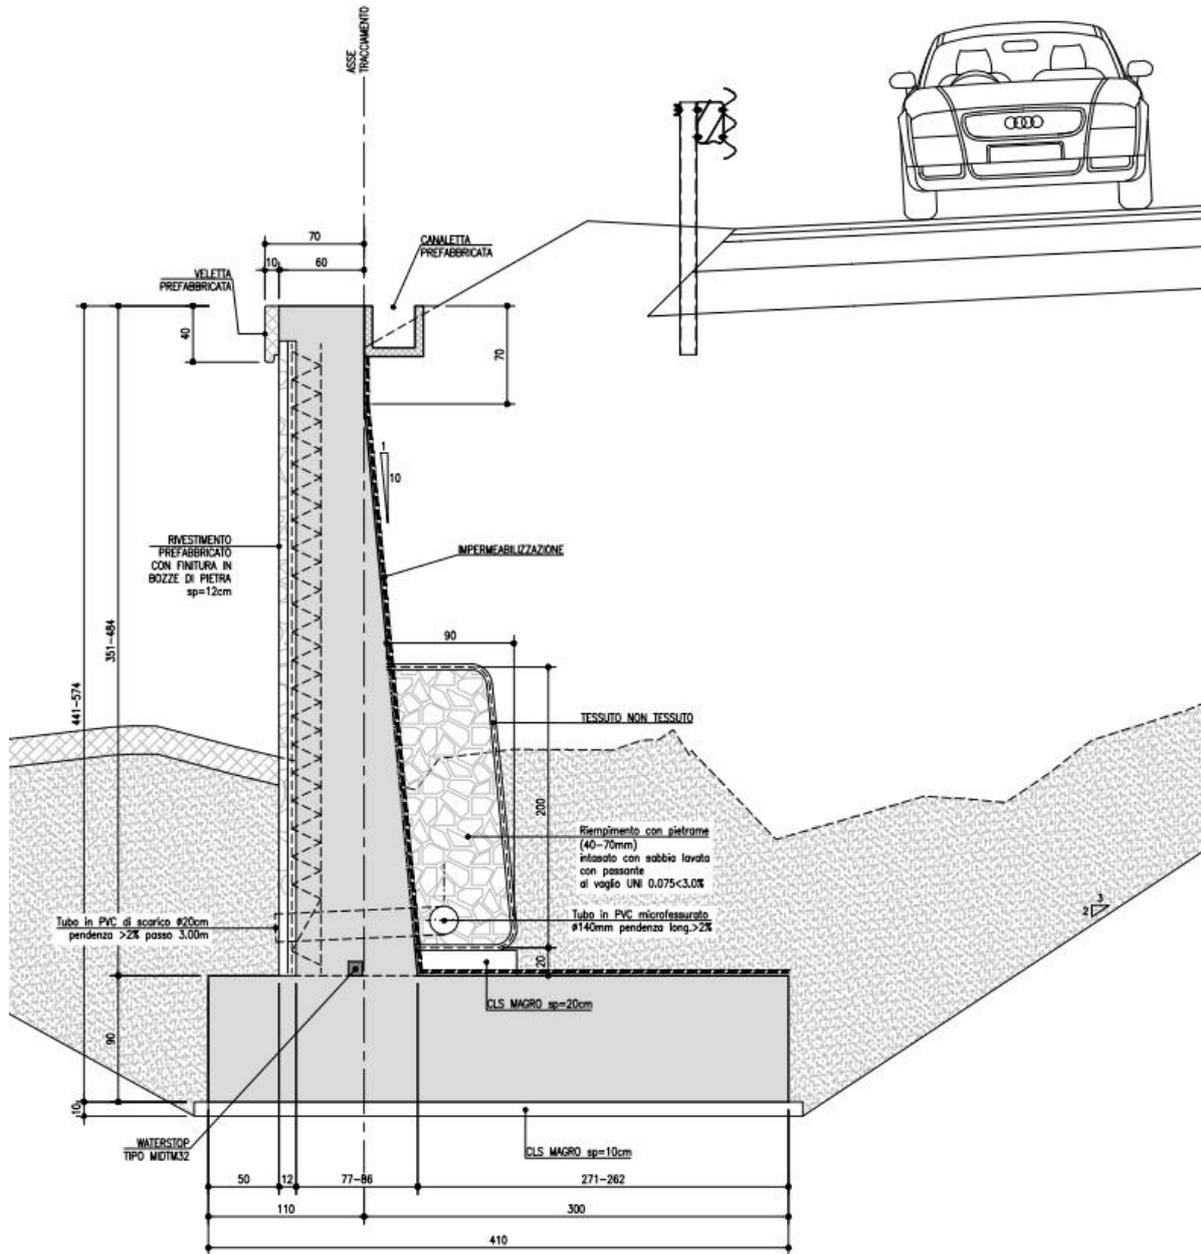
Sezione tipo Muro rivestito di sottoscarpa
